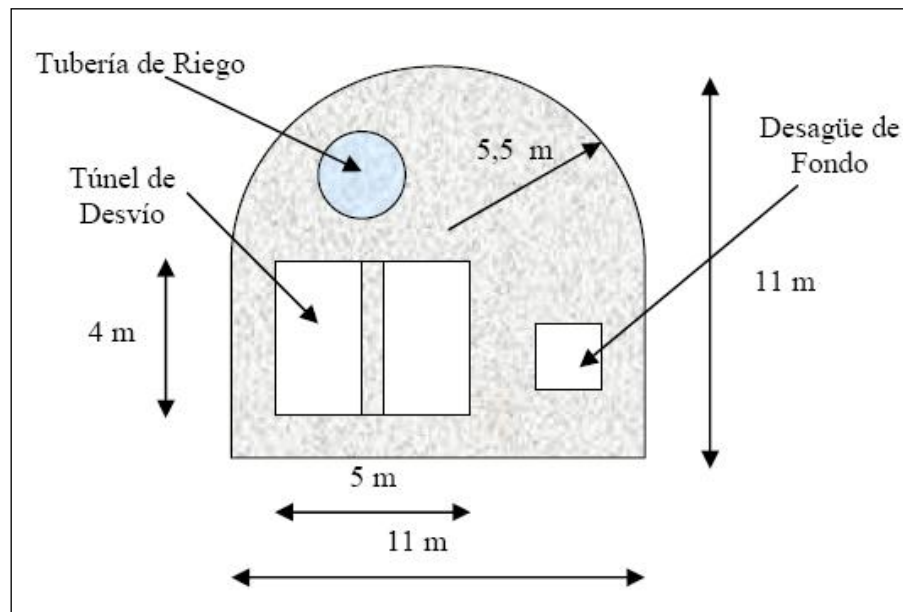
Sección Caverna de Válvulas (Sector tapón). Fuente: proyecto construcción Embalse de Chacrillas.
